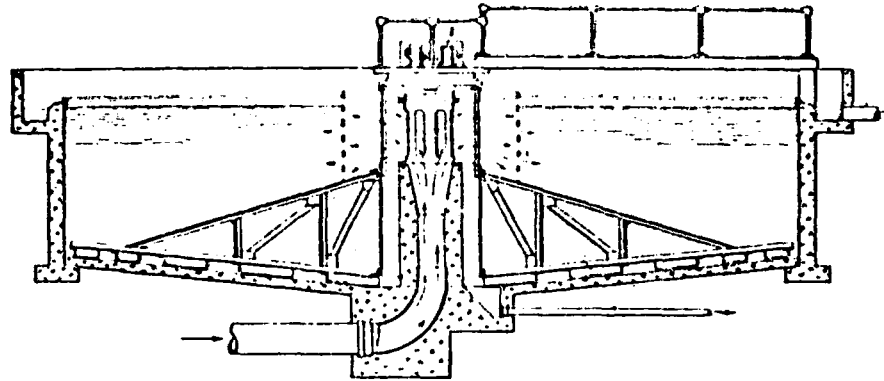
Çökeltme havuzlarının plan şekilleri
